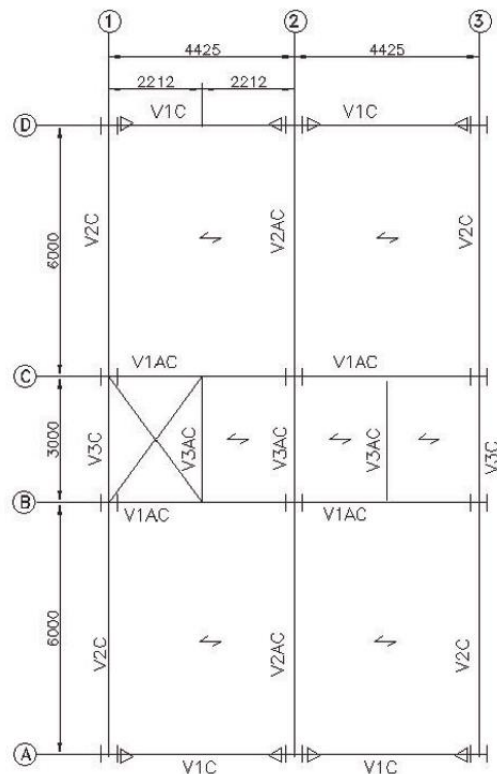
Plano da Vigas EL +12000 - CBCA
